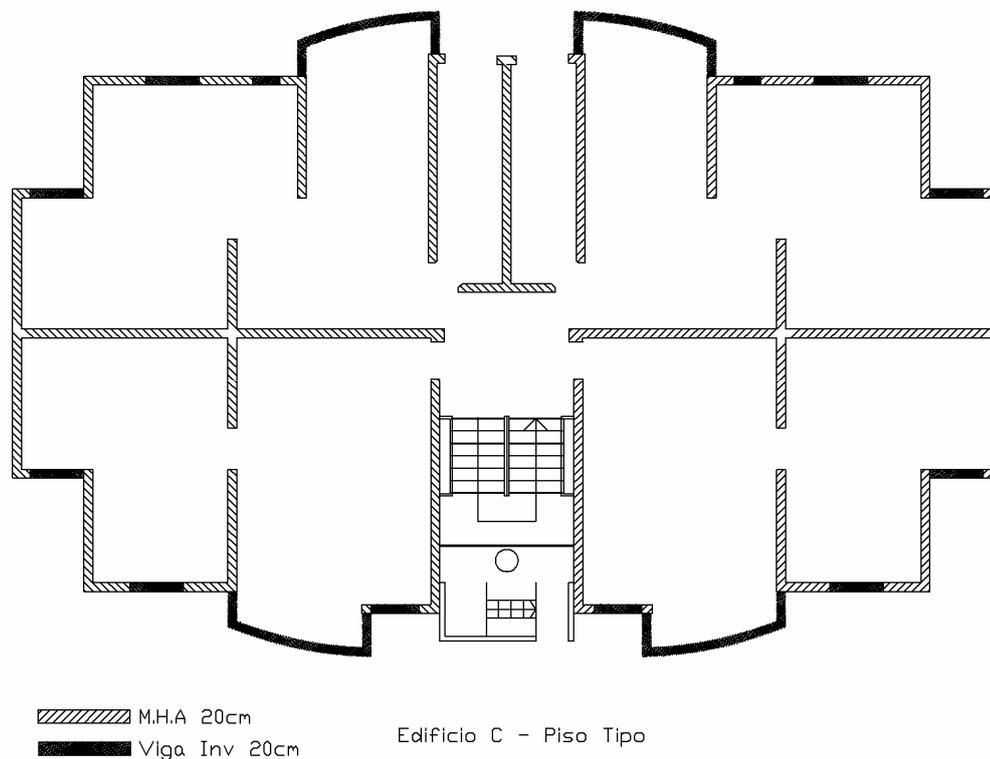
Edificio C, estructuración del Piso Tipo.
